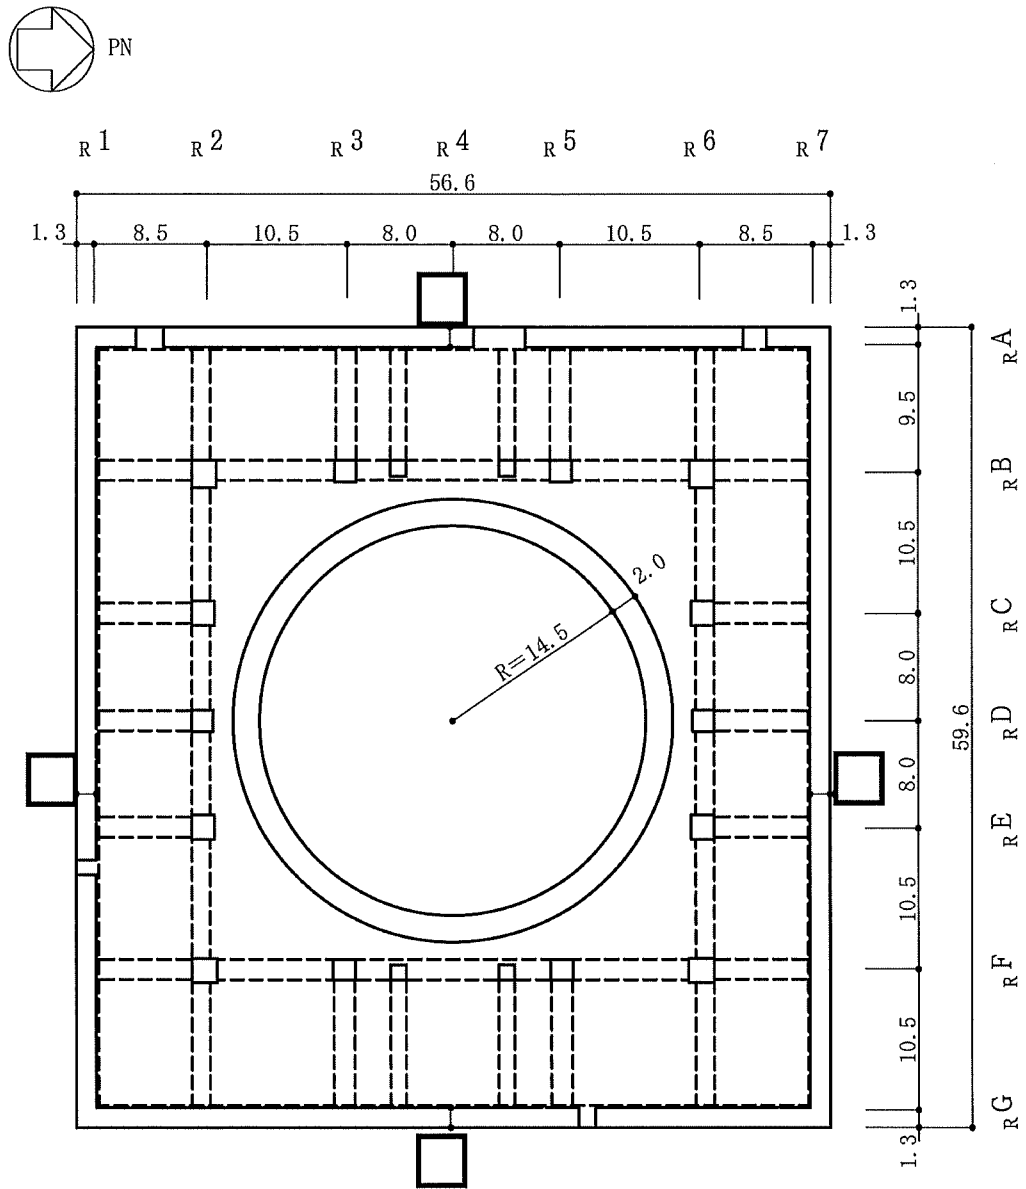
原子炉建屋の概略平面図 (B1F, T.M.S.L. 4.8m) (3/9) (単位 : m)
